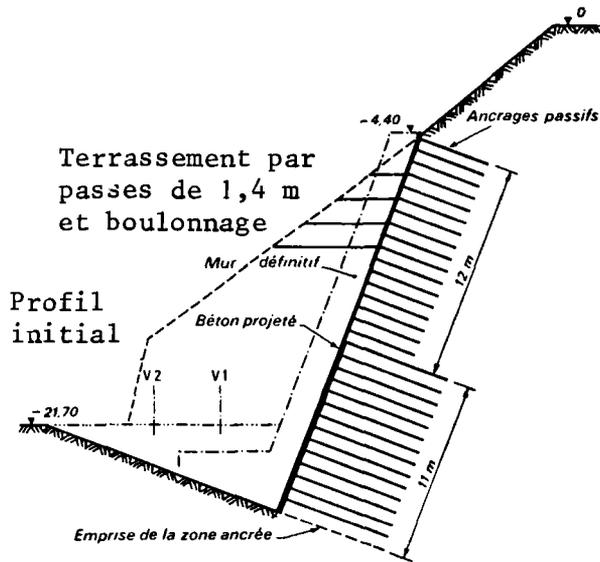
Stabilisation provisoire par massif ancré.
